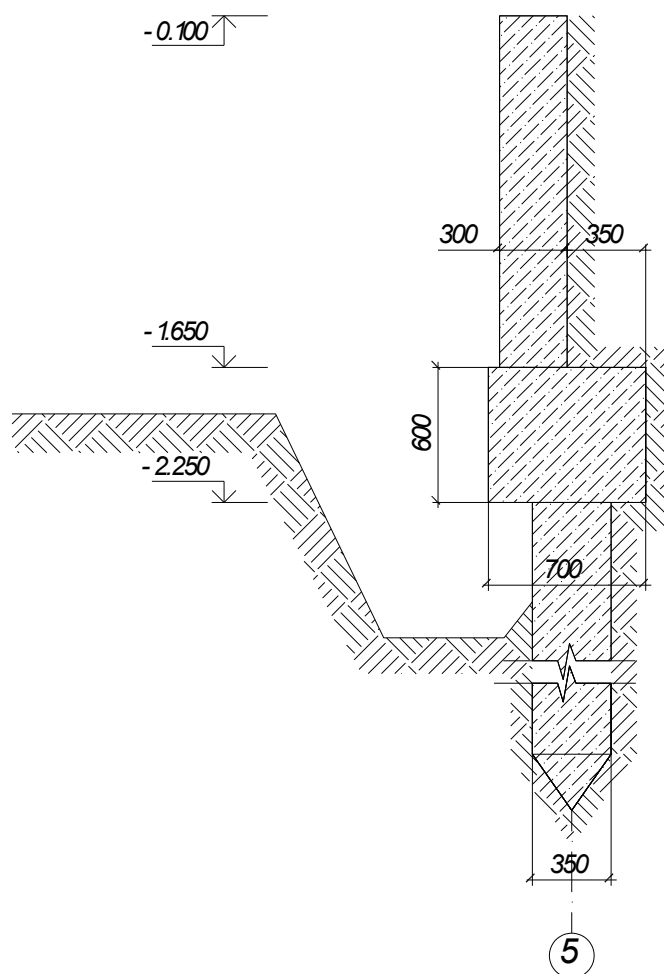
Конструктивное решение опирания наружной стены на ростверк
